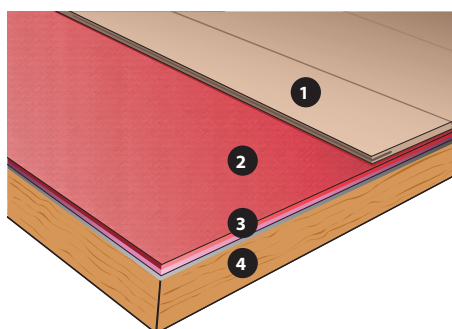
Încălzire în pardoseală cu DEVIDry™ pe planșeu existent din lemn
